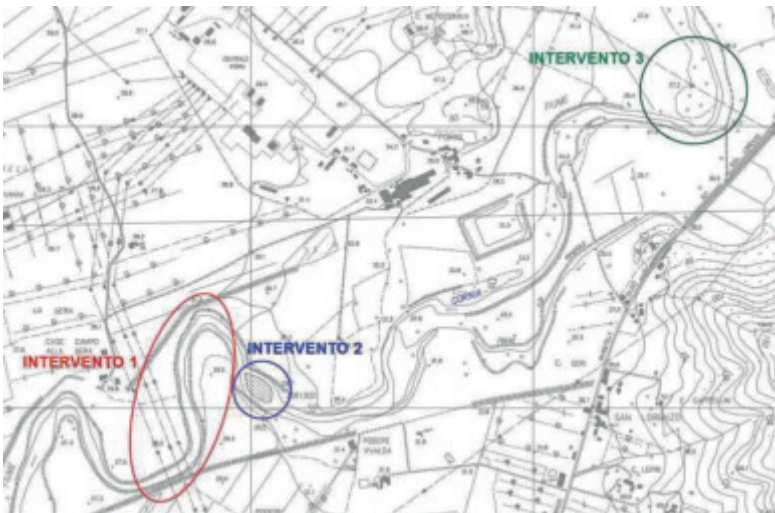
Planimetria generale interventi 1 - 2 - 3
